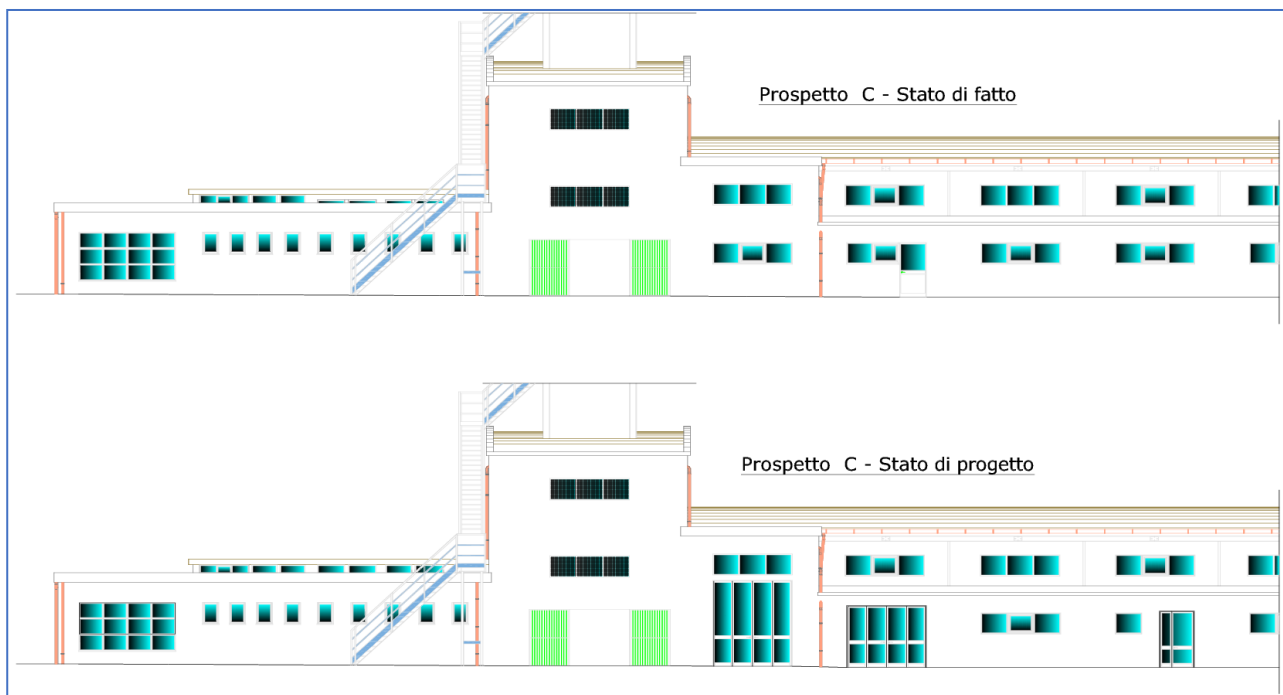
Prospetto posteriore stato di fatto e di progetto
